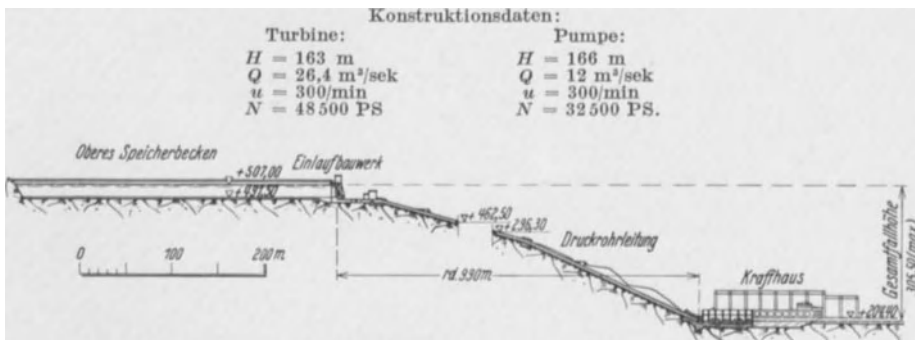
Pumpspeicherwerk Waldeck, Längenschnitt. (Bautechn. 1930.)
